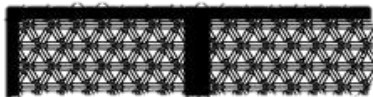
Coupe sur Panneau pour Revêtement de Sol type GC 65
